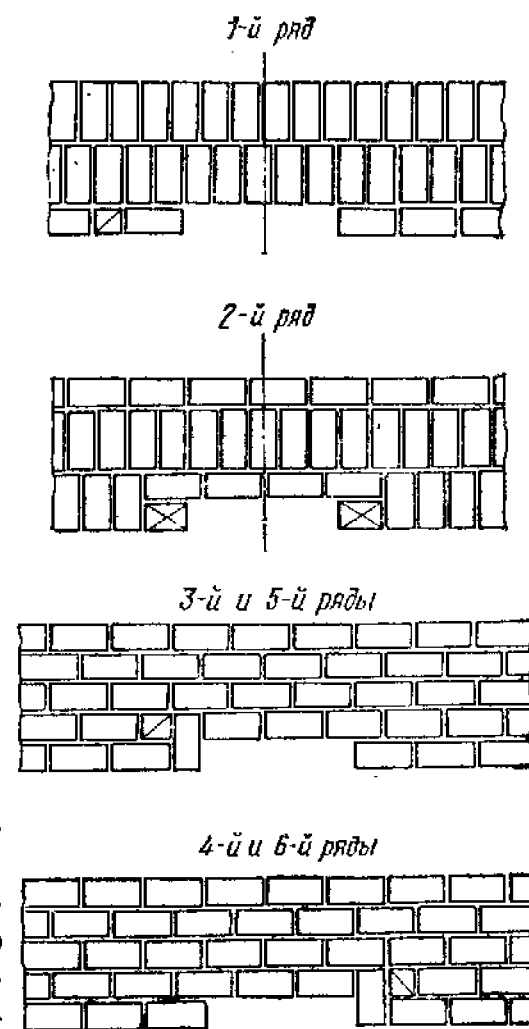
Кладка стены с нишей при многорядной системе перевязки
